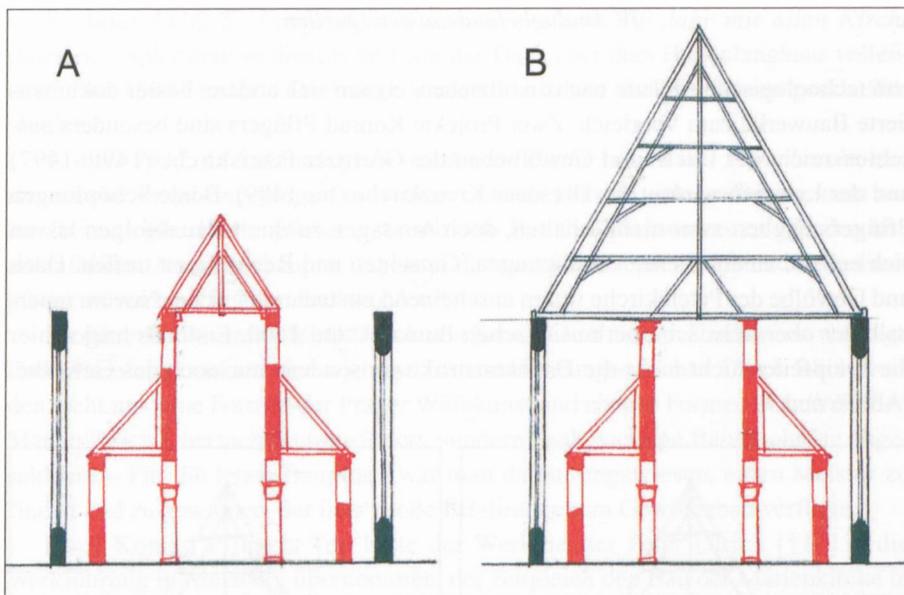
und 9: Skizzen zur Kreuzkirche Dresden, Rekonstruktion der Bauabfolge nach den Bauabrechnungen: A. Bau des neuen Langhauses um die alte Kirche; B. Dachbau mit Unterstützung durch die Hochschiffwände [Abb.: Stefan Bürger].
